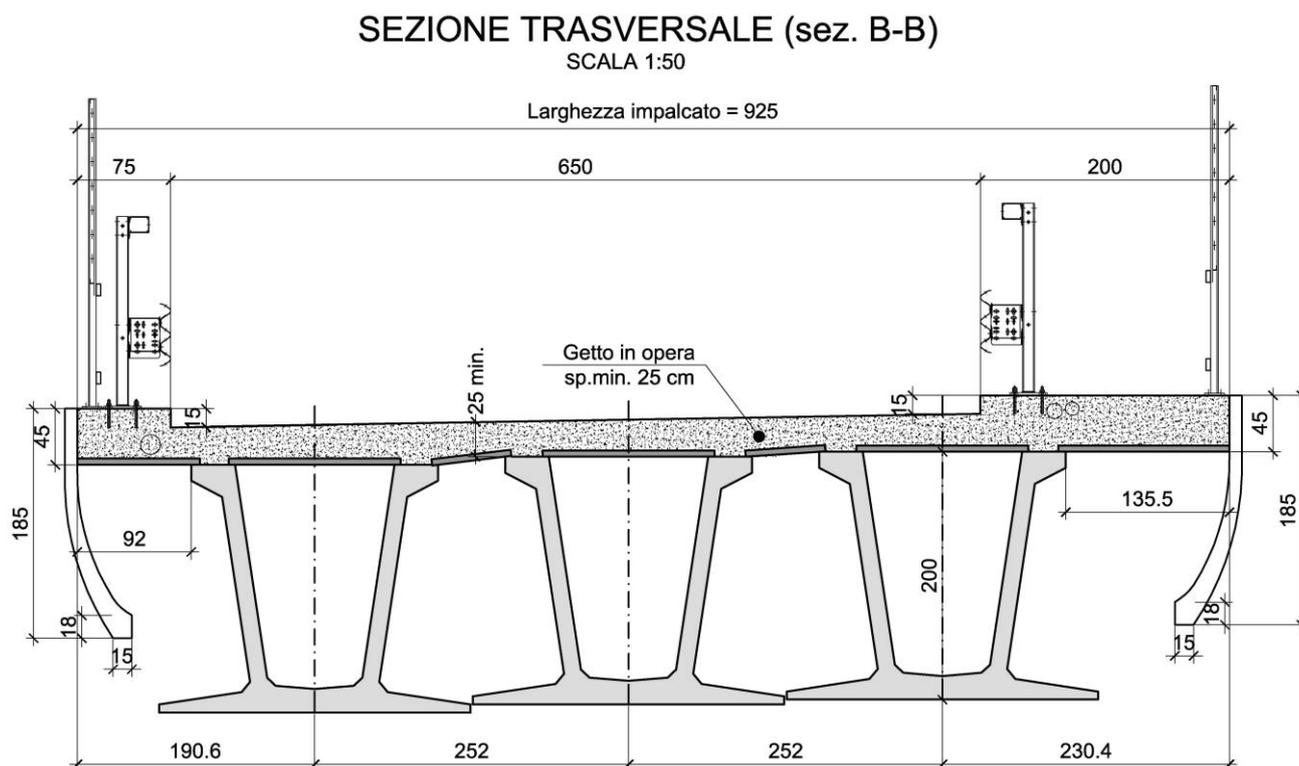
Sezione trasversale impalcato Cavalcavia S.C. via Montepasubio
